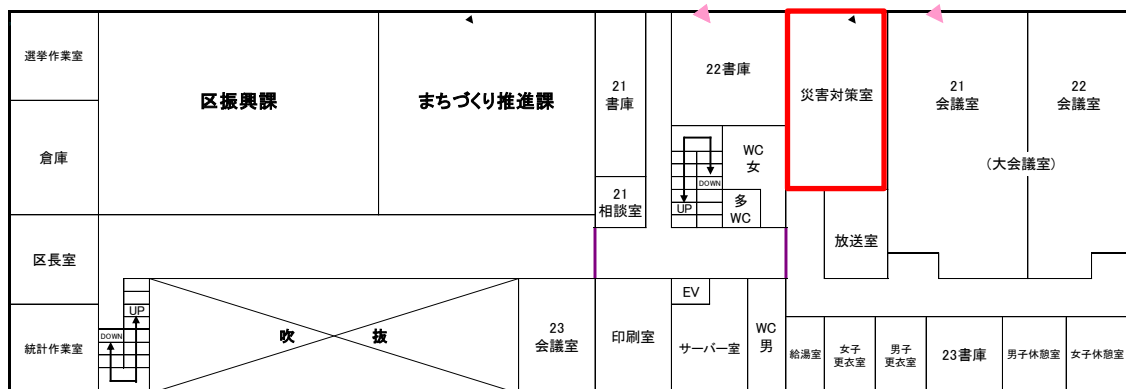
本館（木造）の平面図（赤枠が測定対象部屋）
